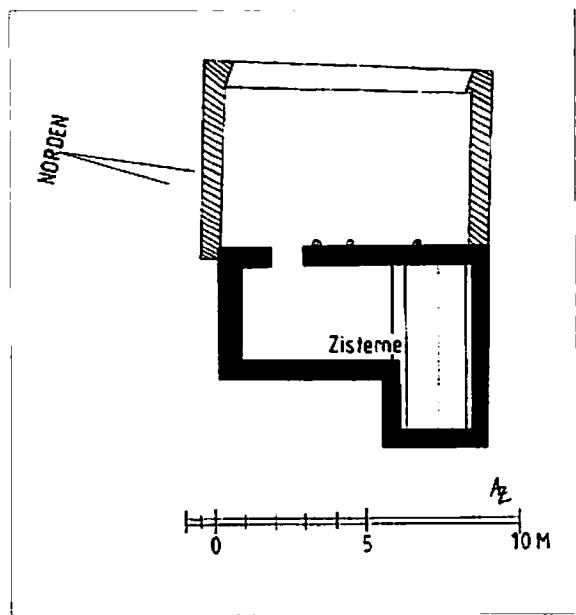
Ala Kilise in Caria, casa di abitazione – planimetria.
